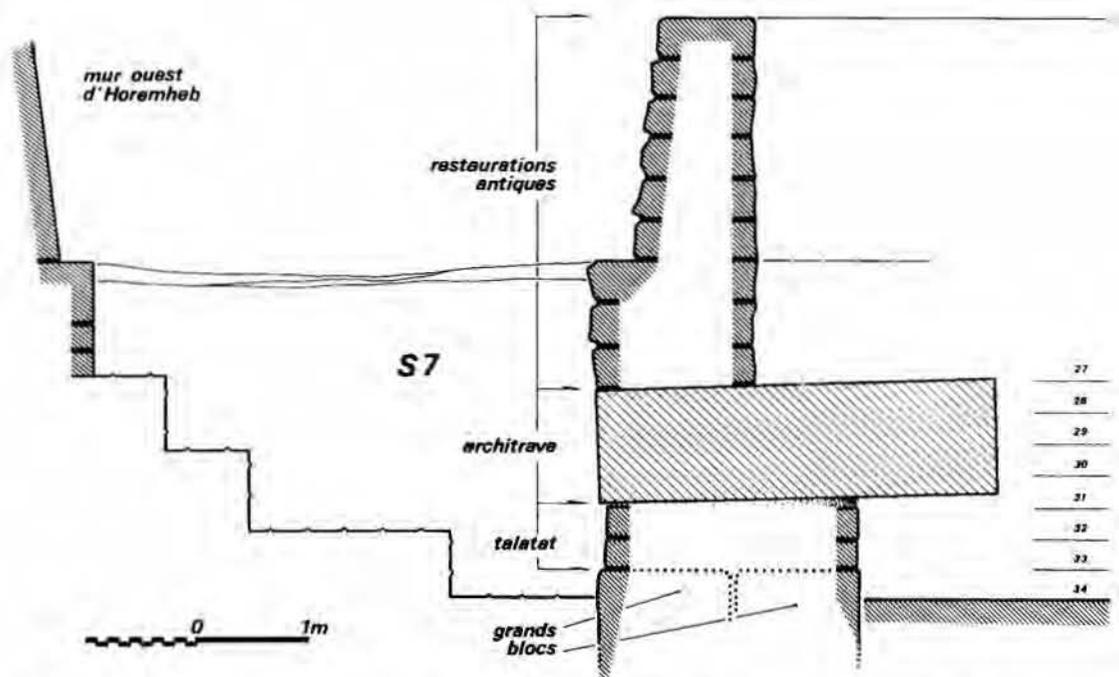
Coupe sur le parement ouest du pylône en fin de chantier, montrant la position des architraves remployées en fondation. Relevé/Dessin : M. Azim.
